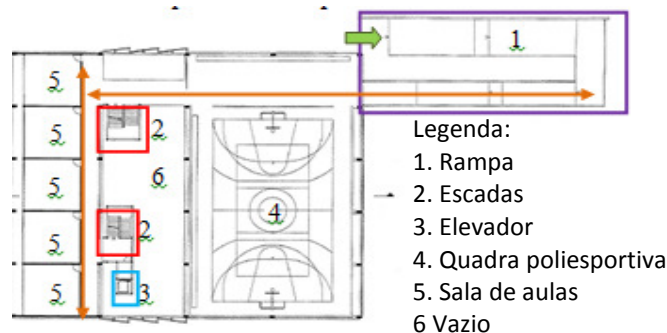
Planta Baixa do 1º pavimento da Fundação para o Desenvolvimento da Educação (FDE) em Campinas.
